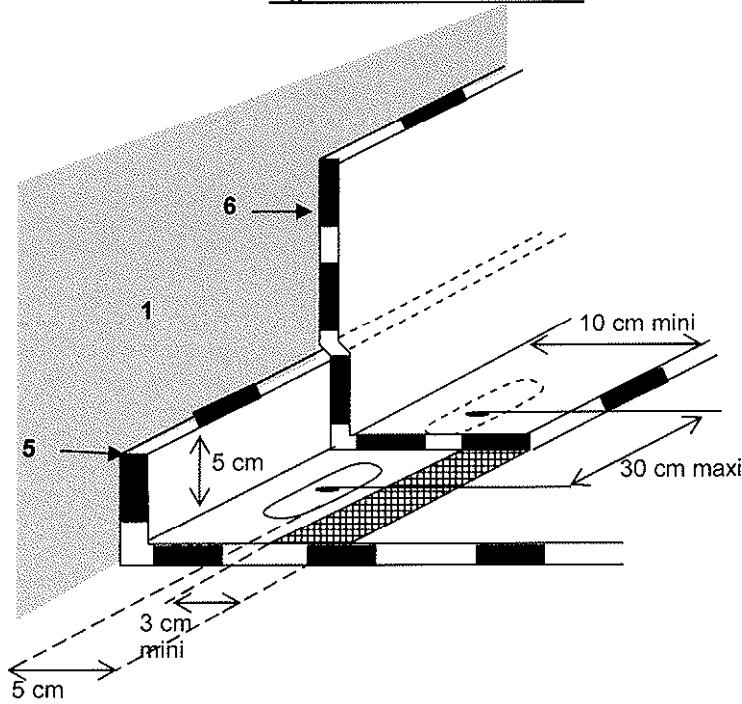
Relevés : recouvrements et soudures : dimensions à respecter
